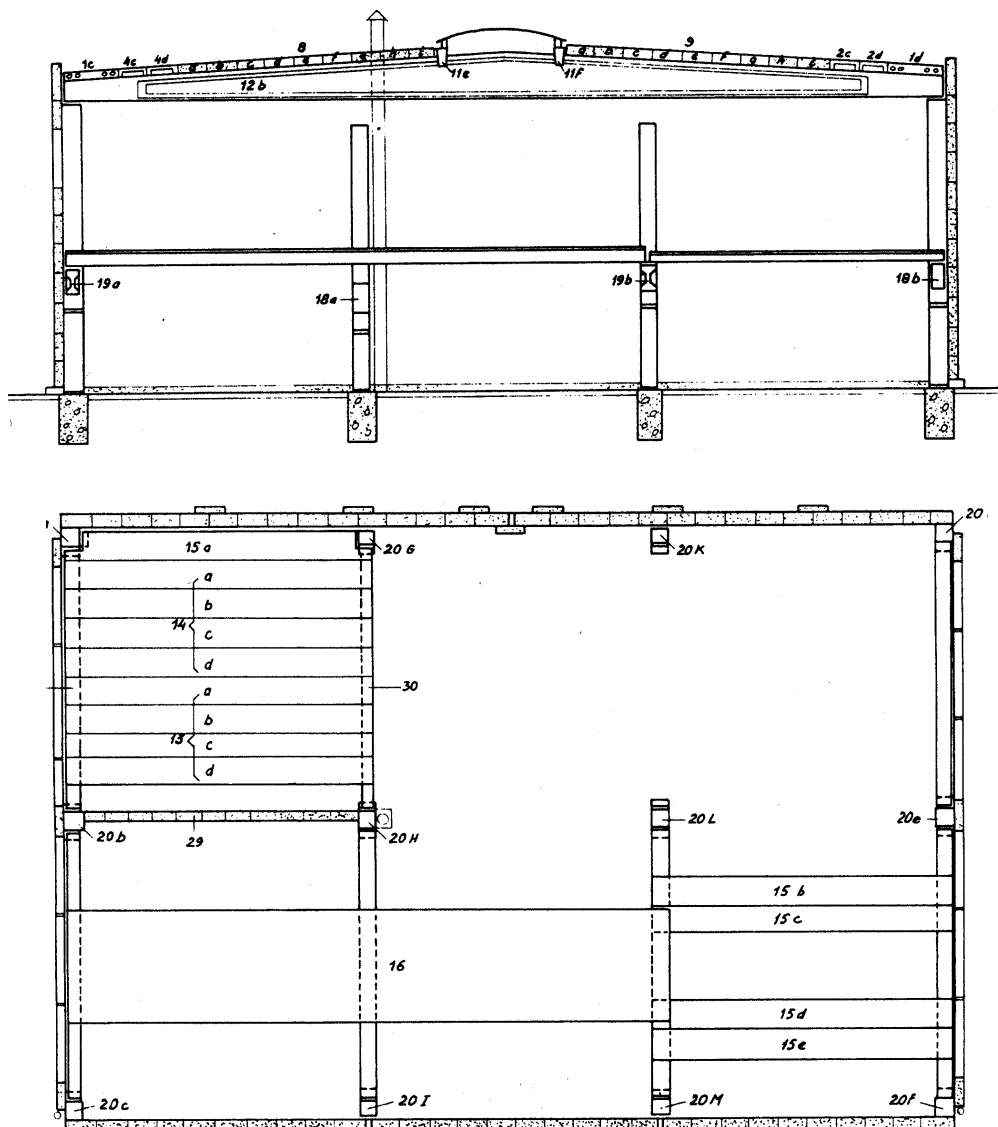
Doorsnede en grondplan van het experimenteel gebouw
